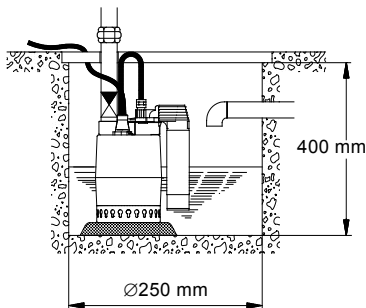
Dimensioni minime del serbatoio per la Unilift KP-AV
